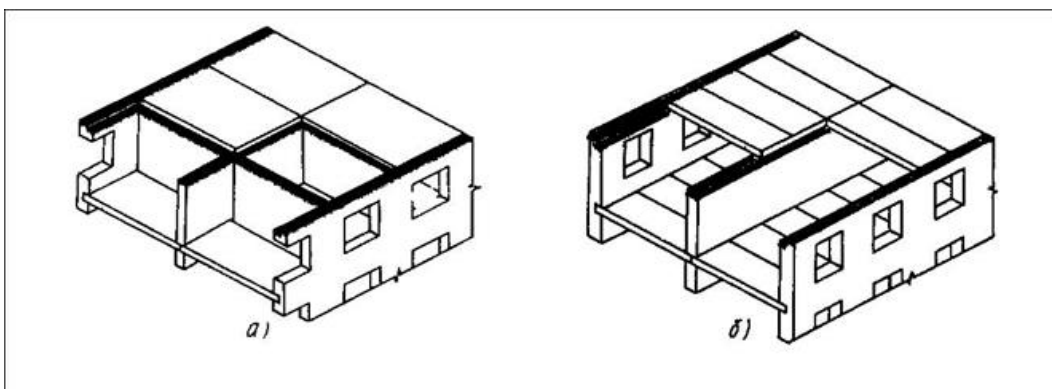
Конструктивні схеми безкаркасних будівель
